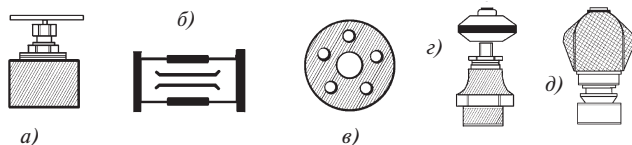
Вентили и прокладки различной конструкции: а) запорный муфтовый вентиль из ковкого чугуна с крышкой на резьбе; б) муфта соединительная с резьбой внутри; в) фланец металлический; г) открытая ГВО; д) закрытая ГВЗ
